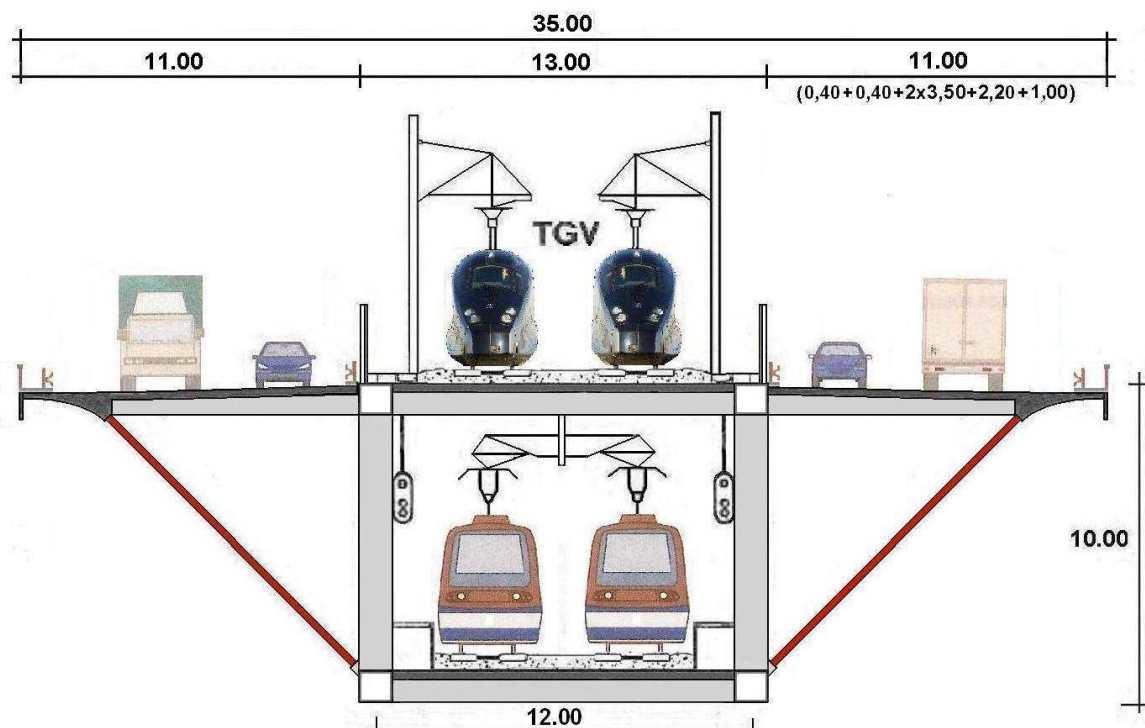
Secção transversal da ponte (1ª Fase+ 2ª Fase)
